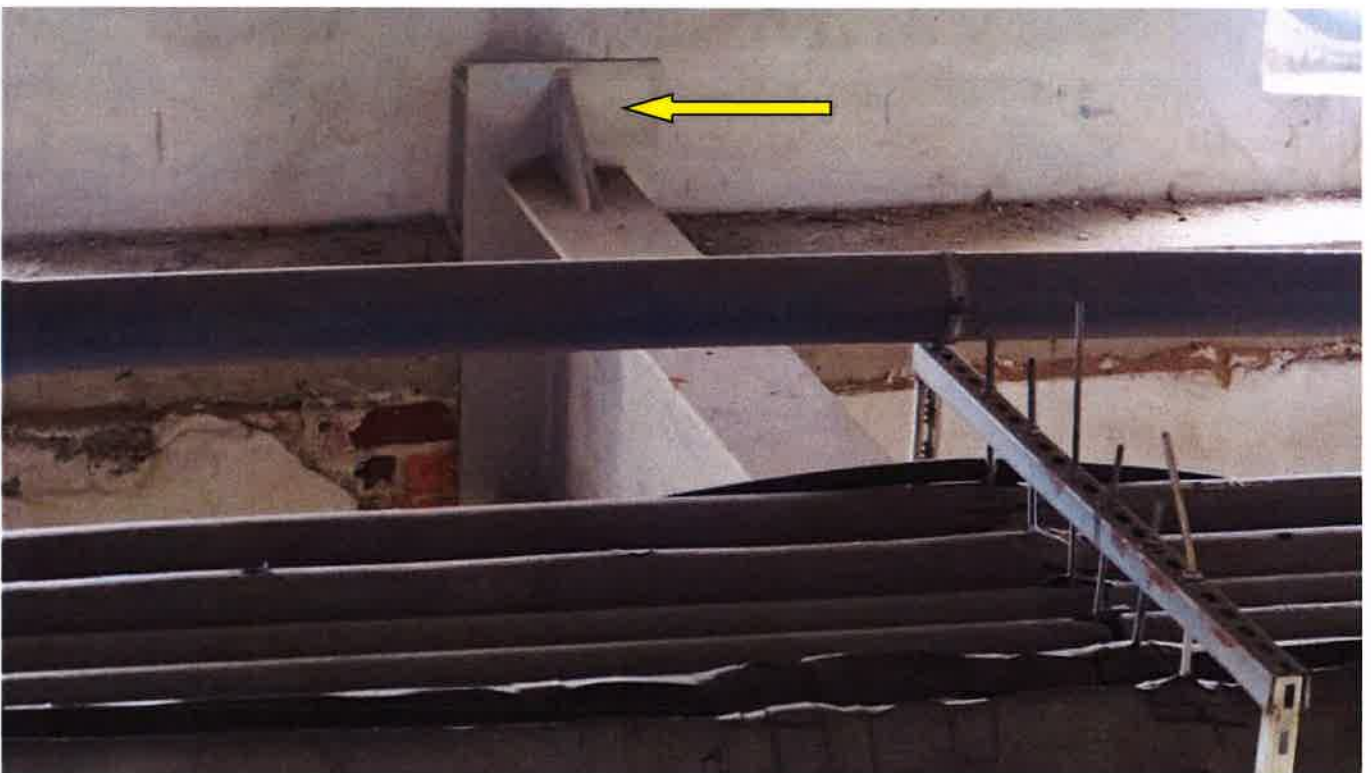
, 33. Płatwie i kratownice stalowe z korozją pod warstwą farby. Cała konstrukcja dachu pod blachą trapezową wadliwie pomalowana, bez oczyszczenia z korozji. Wymagane jest ponowne czyszczenie i malowanie całej konstrukcji pokrycia dachu. (uwaga: malowanie farbą „pęczniejącą”, dającą ochronę p-poż.)
